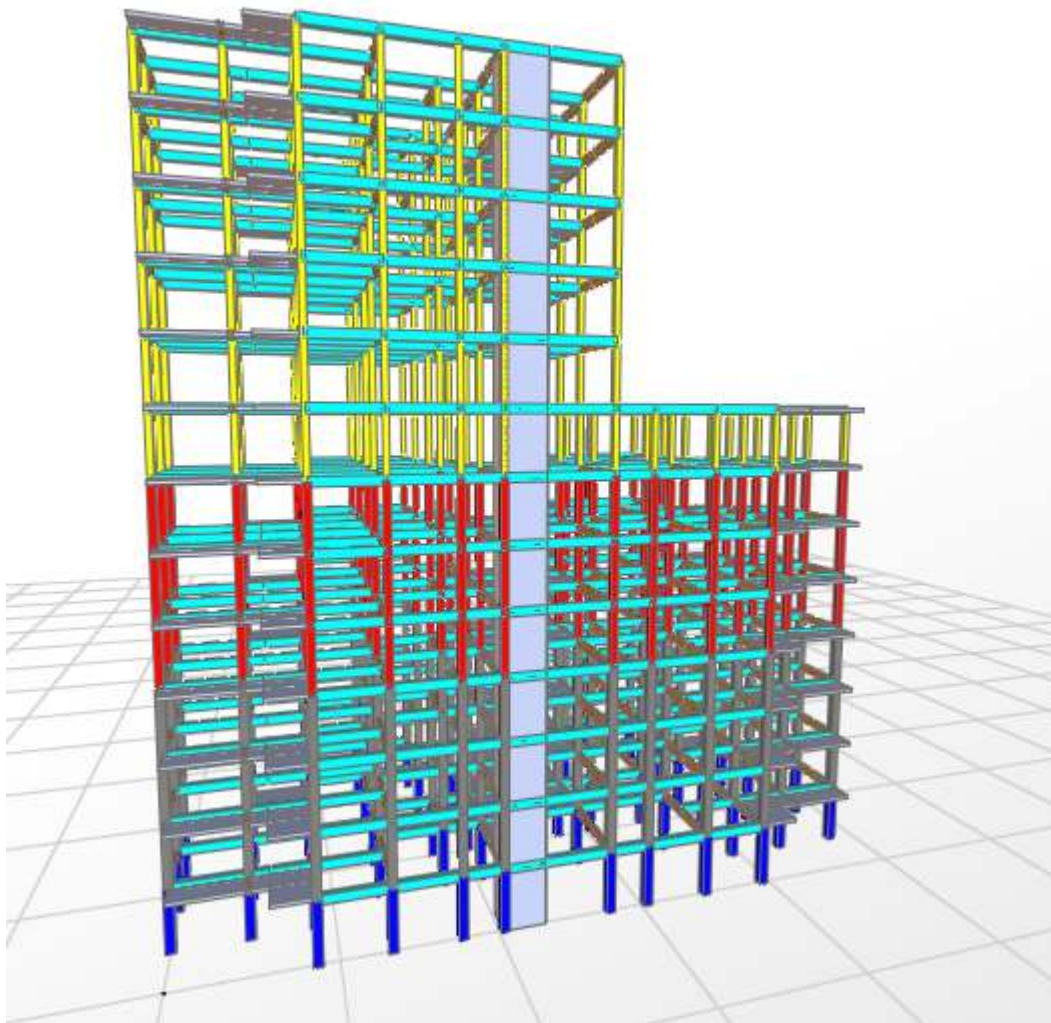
Model initial (poteaux + poutre + voile de cage escalier)
